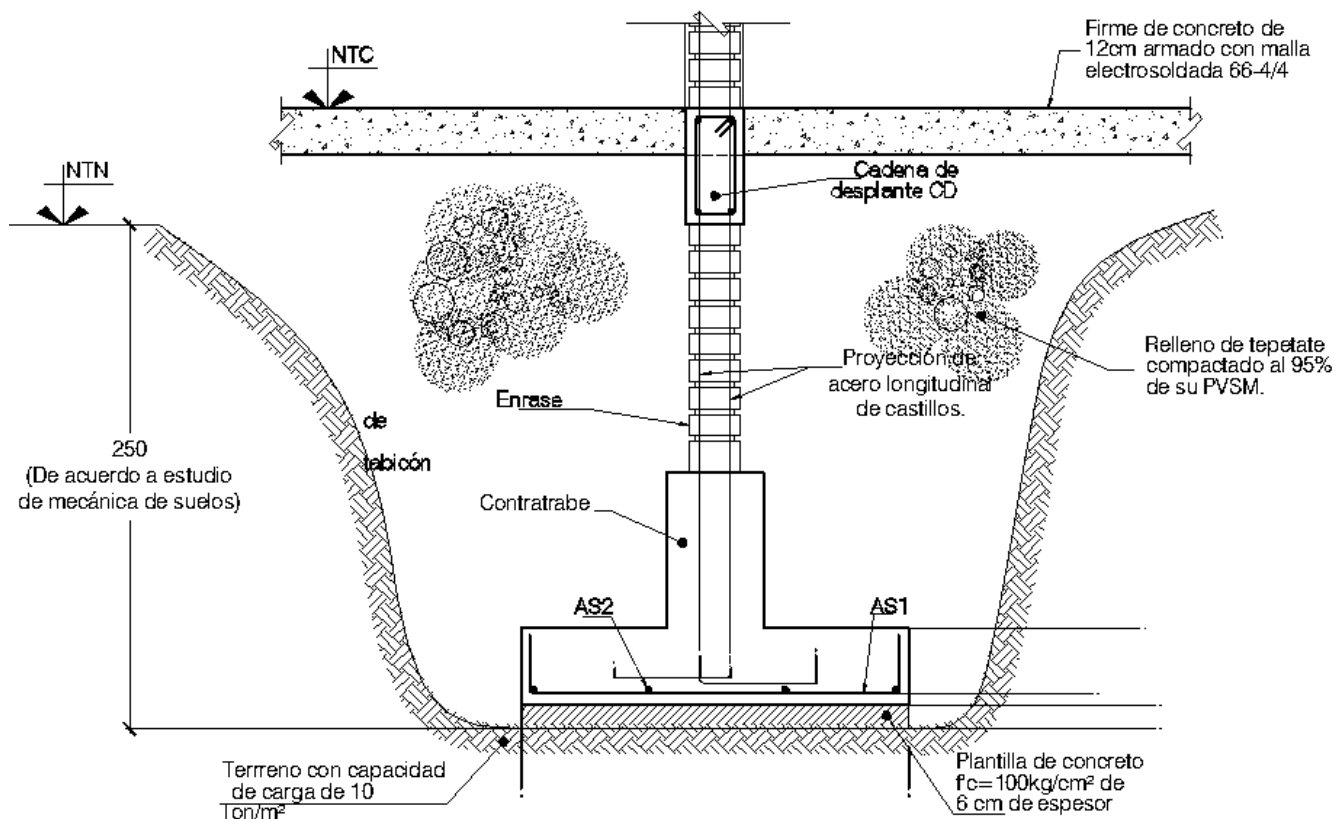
Zapata tipo de ambos proyectos, original y actual).
